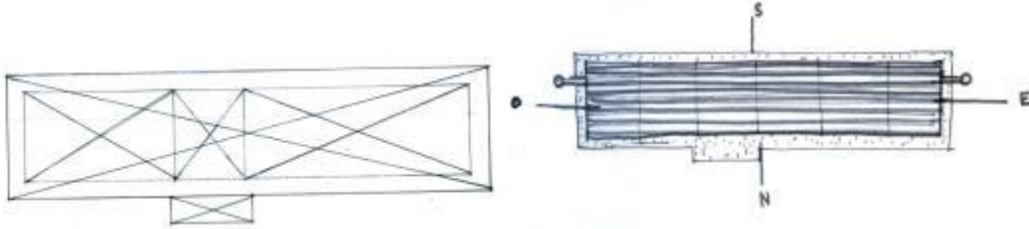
y Geometría y Orientación Magney House. Croquis realizado por el autor.
